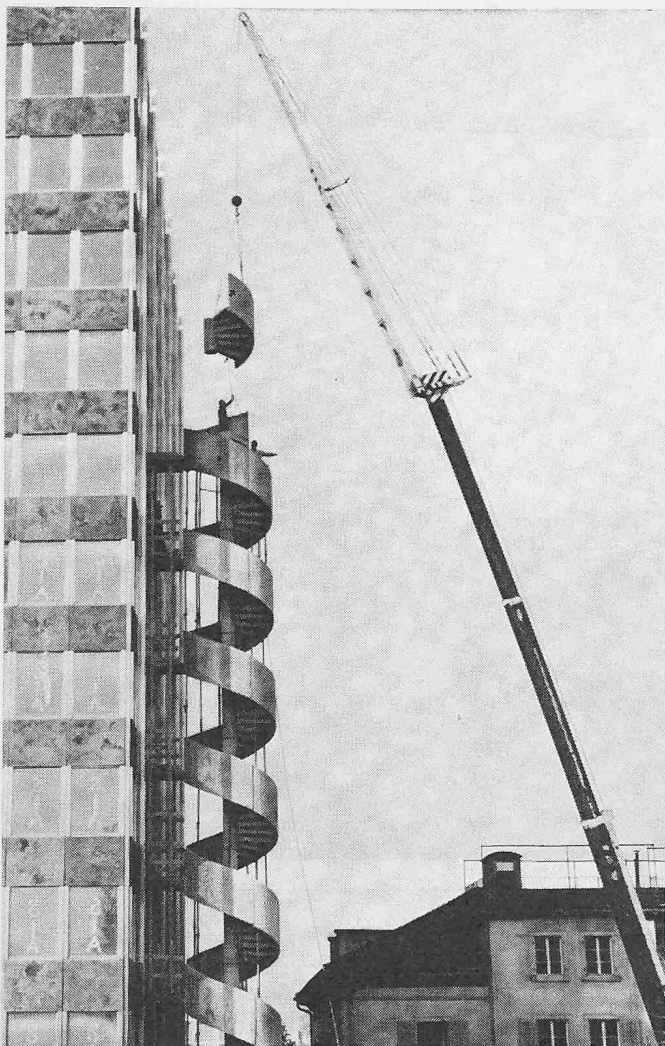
Montage eines vorfabrizierten Beton-Treppenelementes mit Autokran
